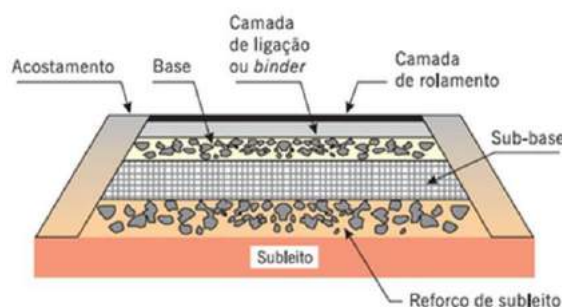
Constituição do Pavimento, apresentado por Bianchi et al. (2008).
